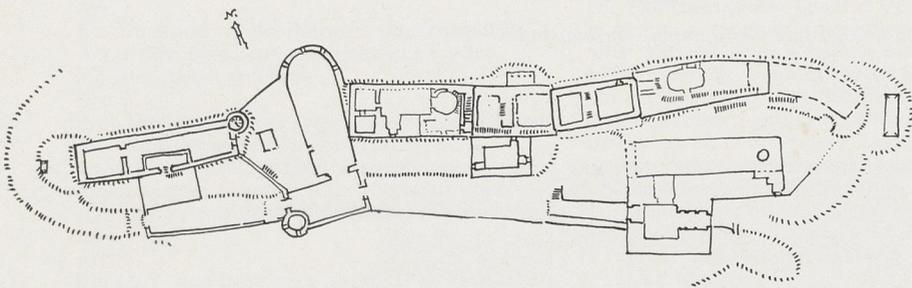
Drachenfels/Pfalz bei Dahn. Lageplan
